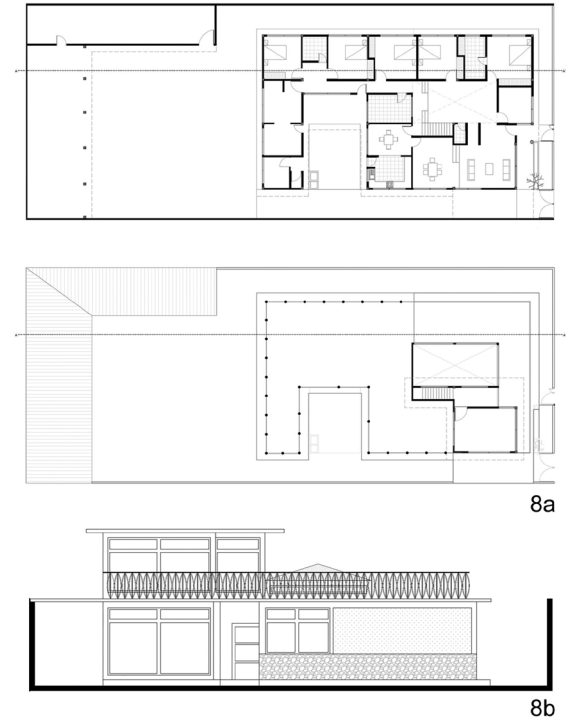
, Plantas arquitectónicas, elevación y sección constructiva casa Rodríguez.
